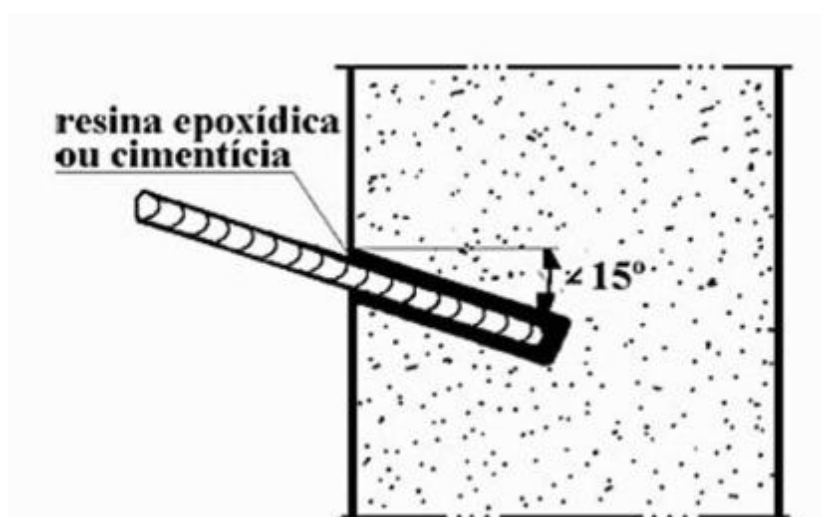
Posição dos furos para a ancoragem das barras ao concreto.
